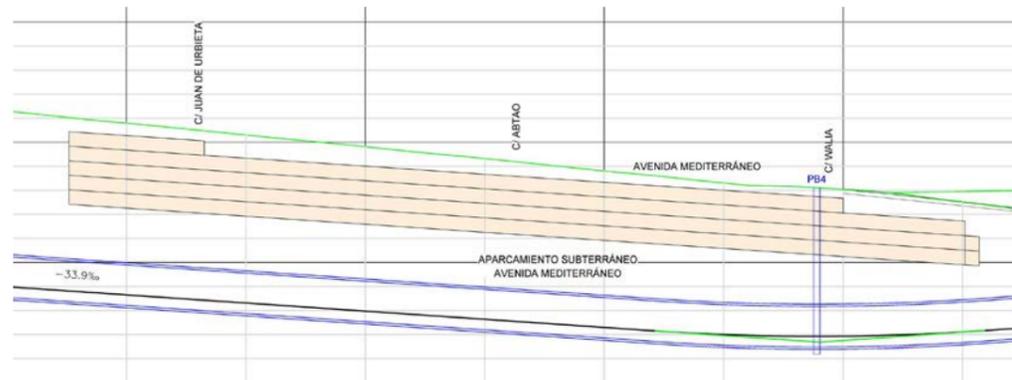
Alzado longitudinal del aparcamiento subterráneo situado en la Avenida del Mediterráneo
